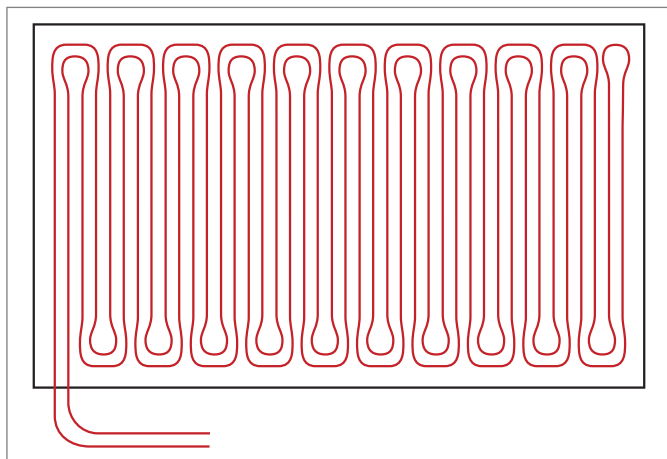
Sistema di raffreddamento/riscaldamento a soffitto REHAU
